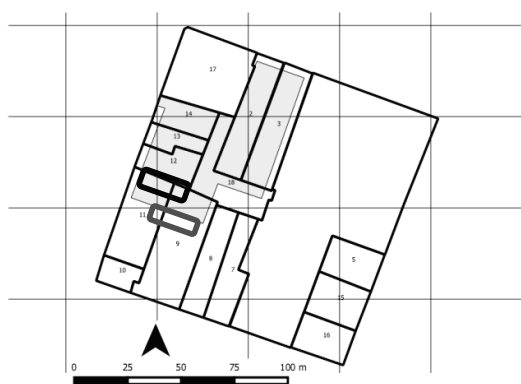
Plan de mitigación. En negro: ubicación actual del muro en su posición primaria; en gris: el lugar planificado para su disposición provisoria.
